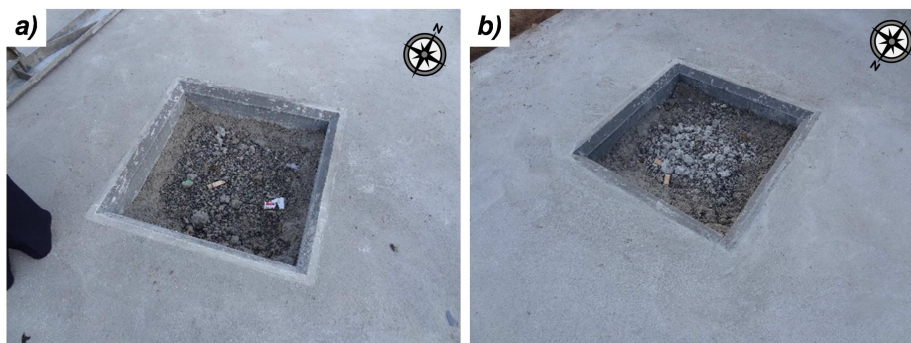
67 – Alcorques situados en la losa con hormigón tipo HM-20/20/B
